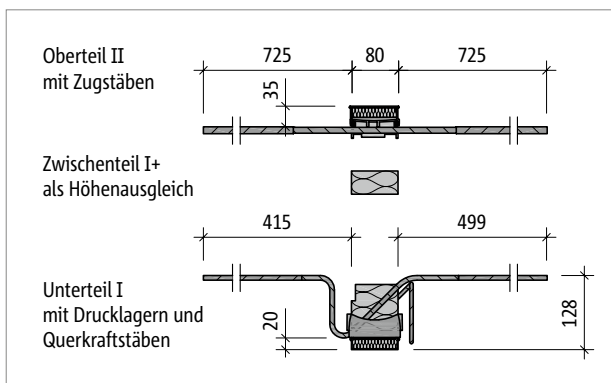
Schöck Isokorb® T Typ KL-F M8 bis M12
